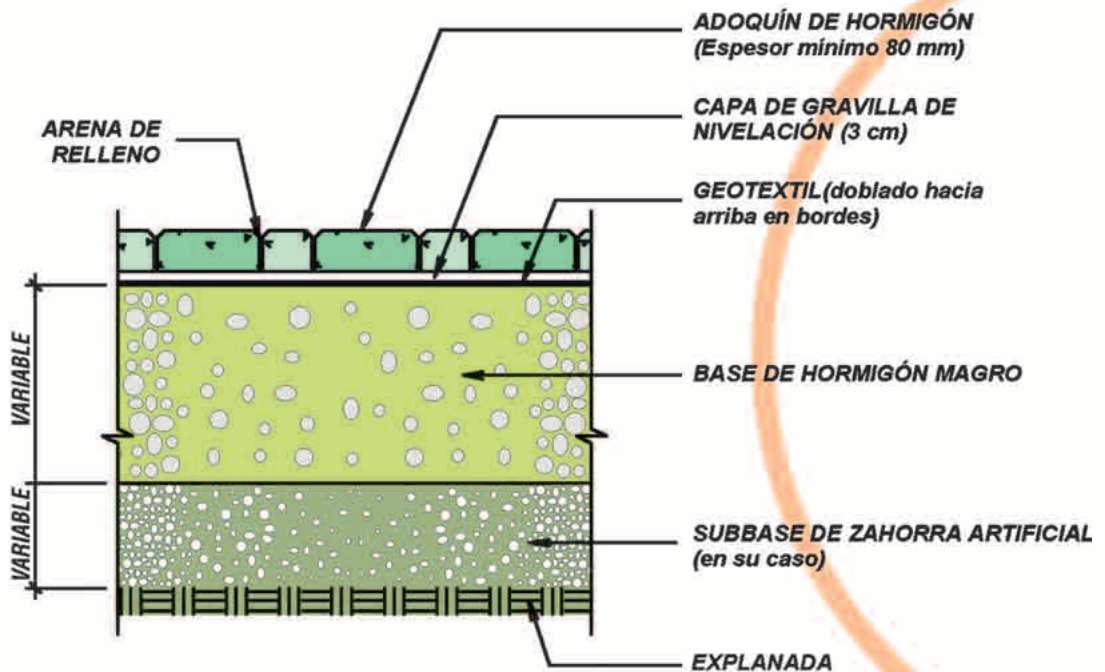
Sección tipo de firme con pavimento de adoquines
